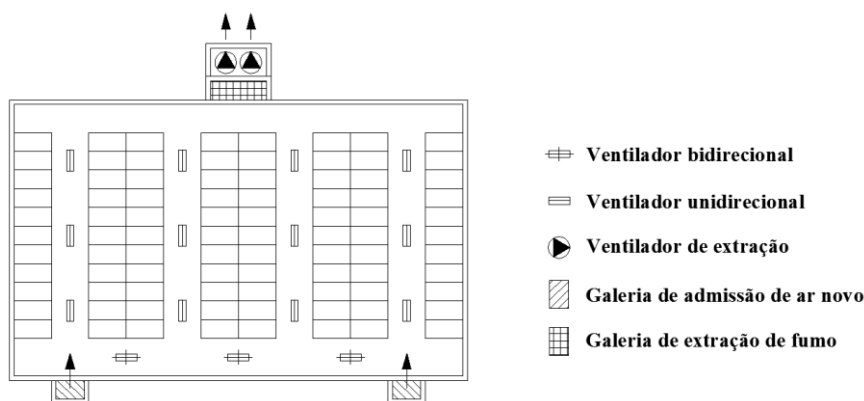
Planta de parque de estacionamento com ventilação de impulso (adaptado de [25])
